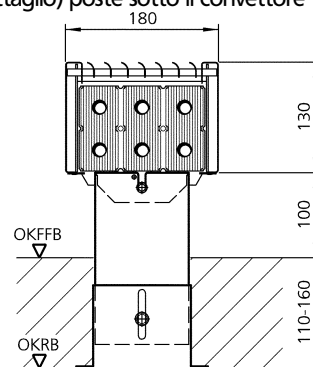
Sezione: Montaggio sul pavimento grezzo
